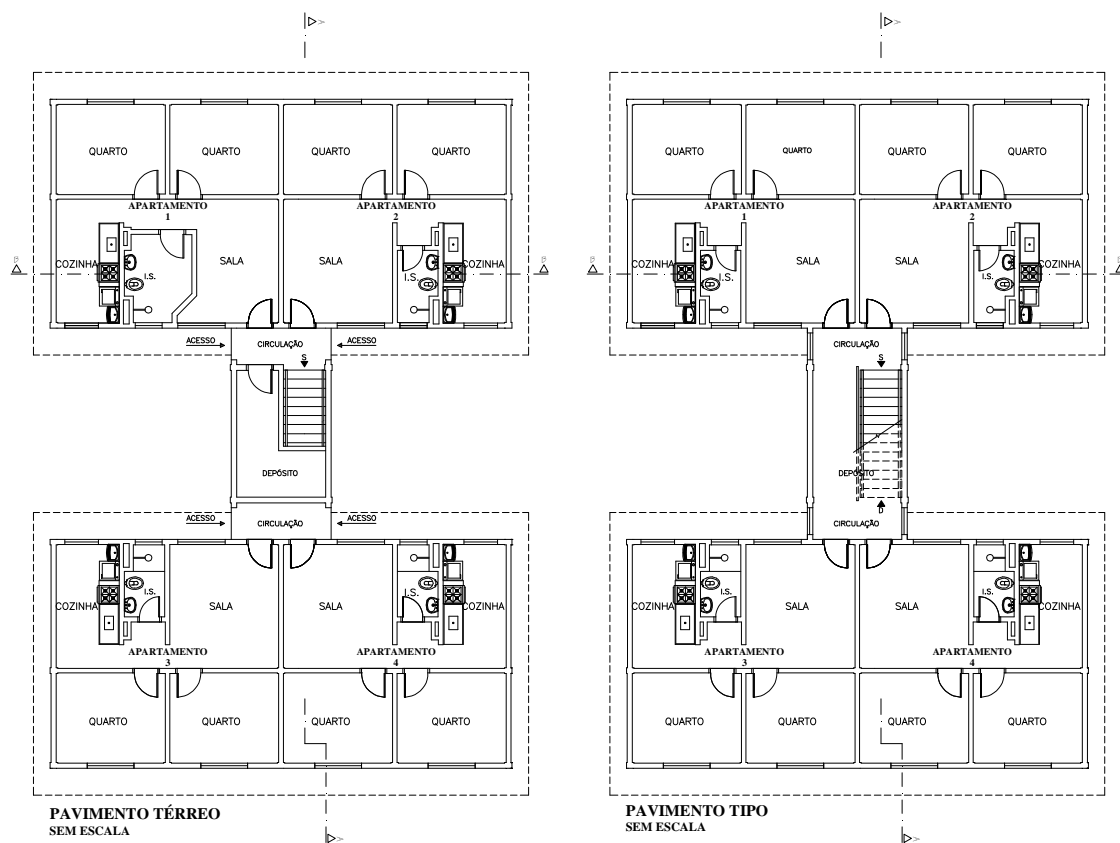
Planta tipo de edifício habitacional de cinco pavimentos.
